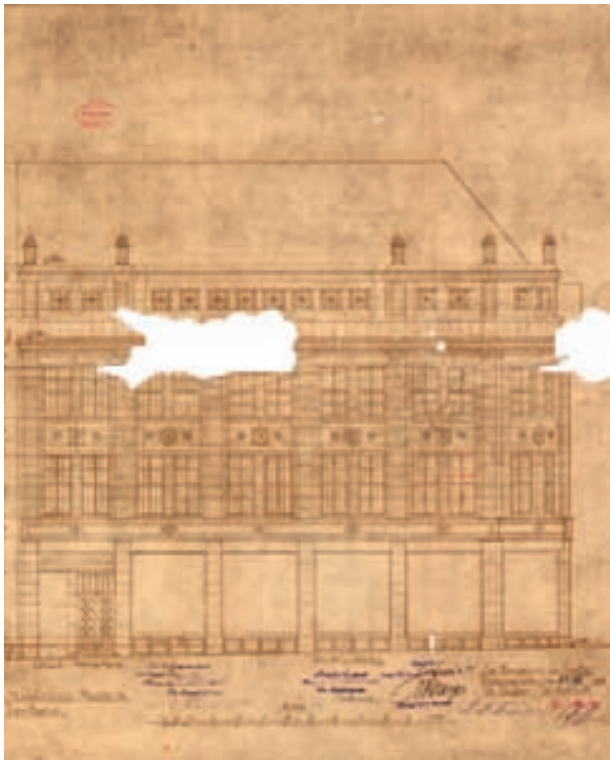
Menden, Hauptstraße 57, Baueingabeplan 1914, Ansicht Turmstraße (Bauakten der Bauverwaltung, Stadt Menden)
